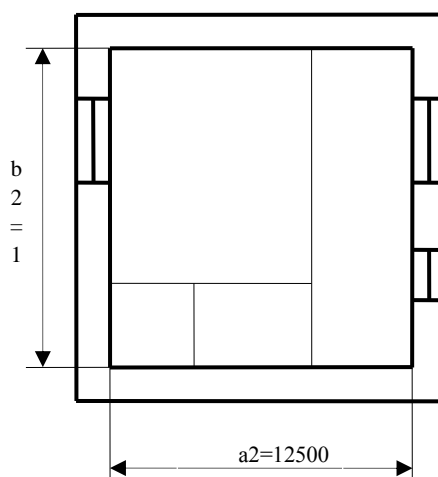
Конструктивні розміри 1-го поверху
